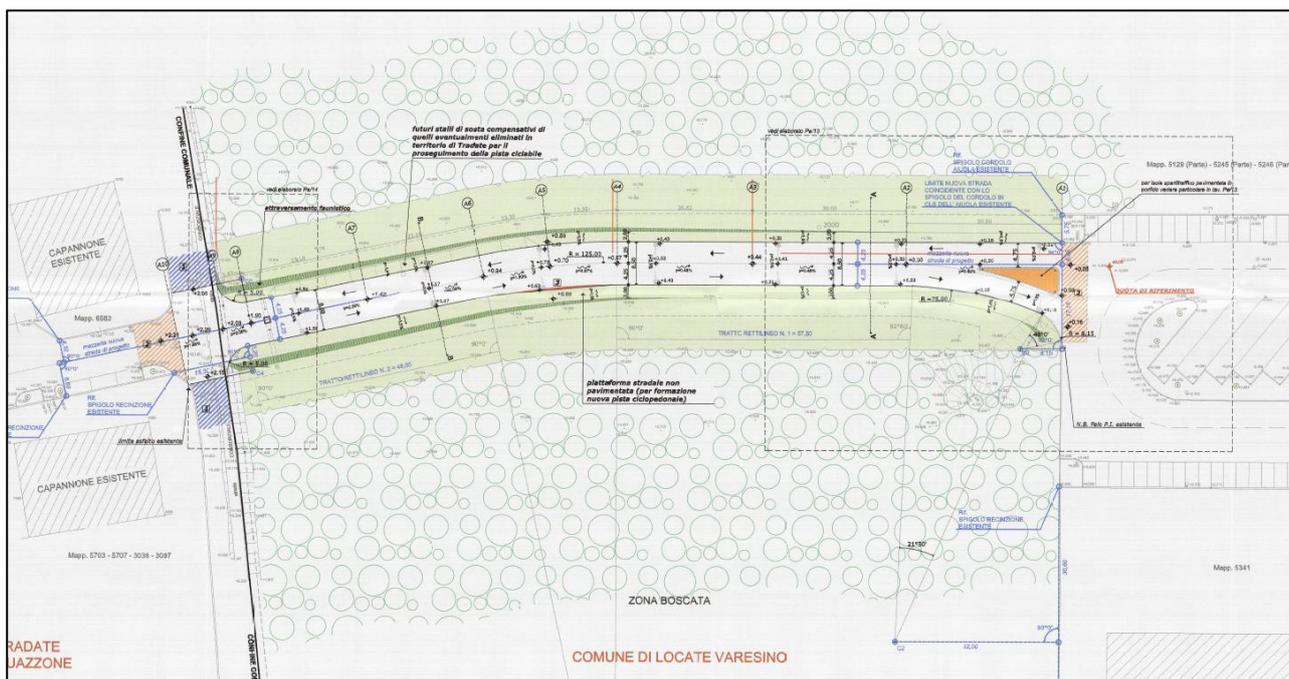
Stralcio della tavola di progetto Pe 09 con planimetria delle opere in progetto.
